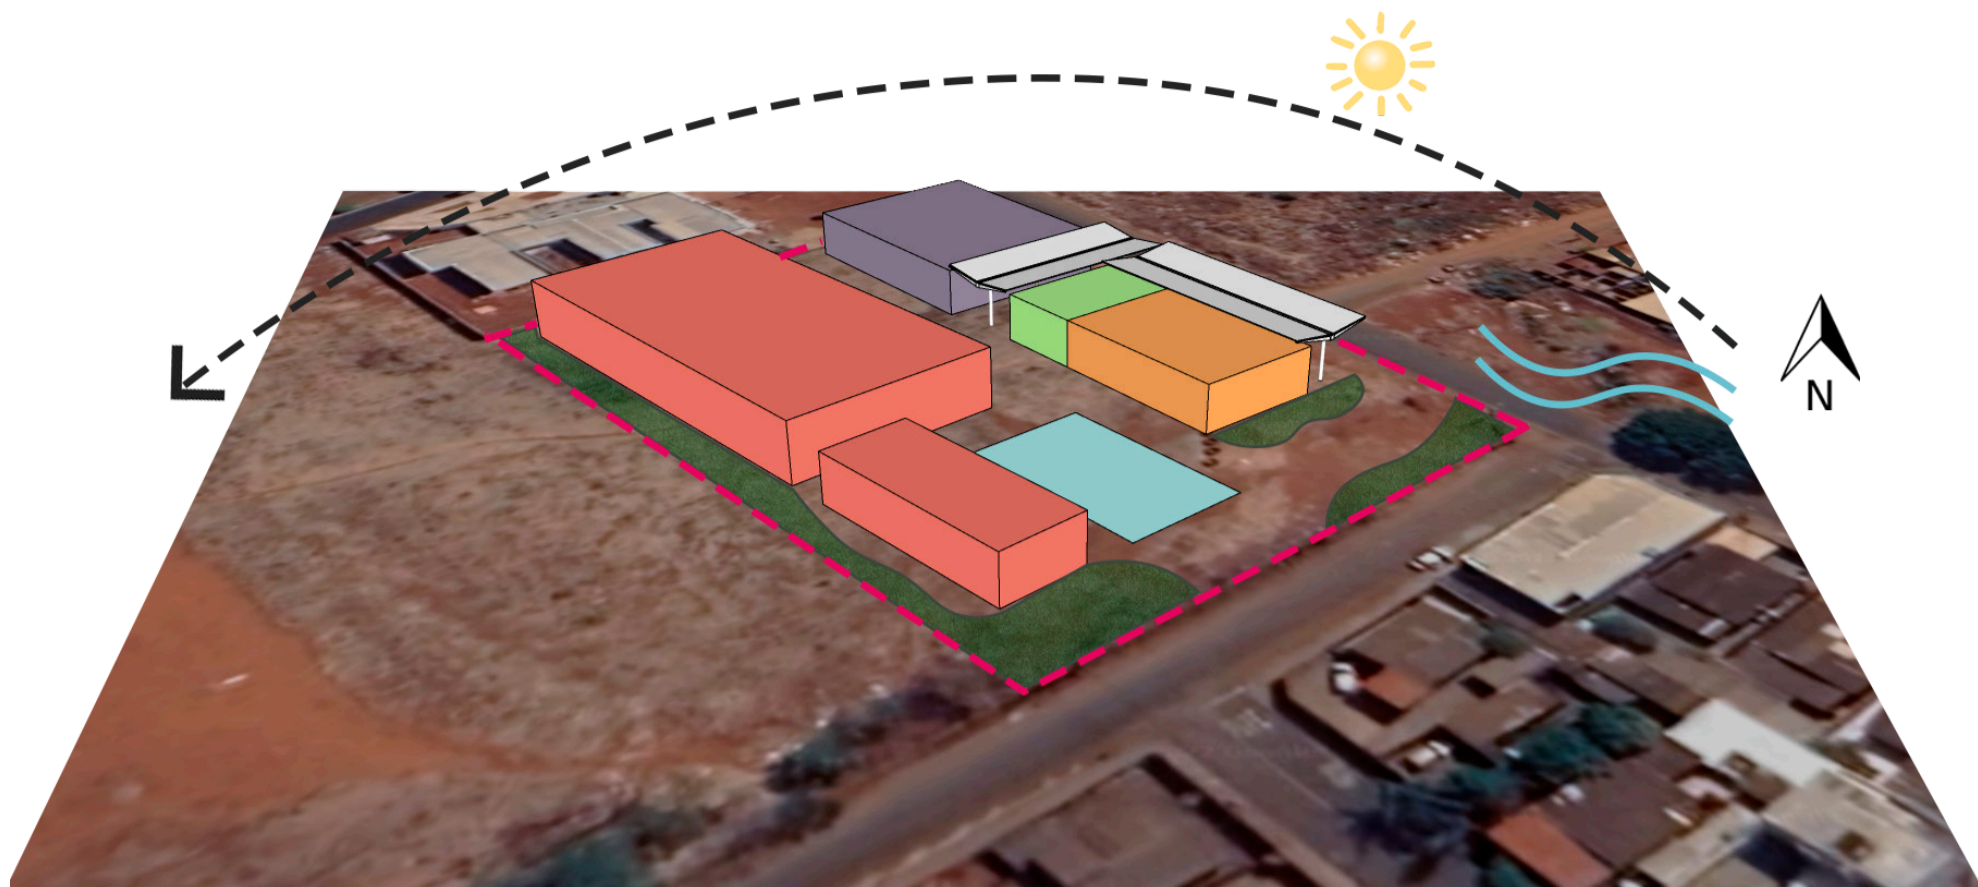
Proposta preliminar de implantação do Centro no bairro Glória. Fonte: Autora.
